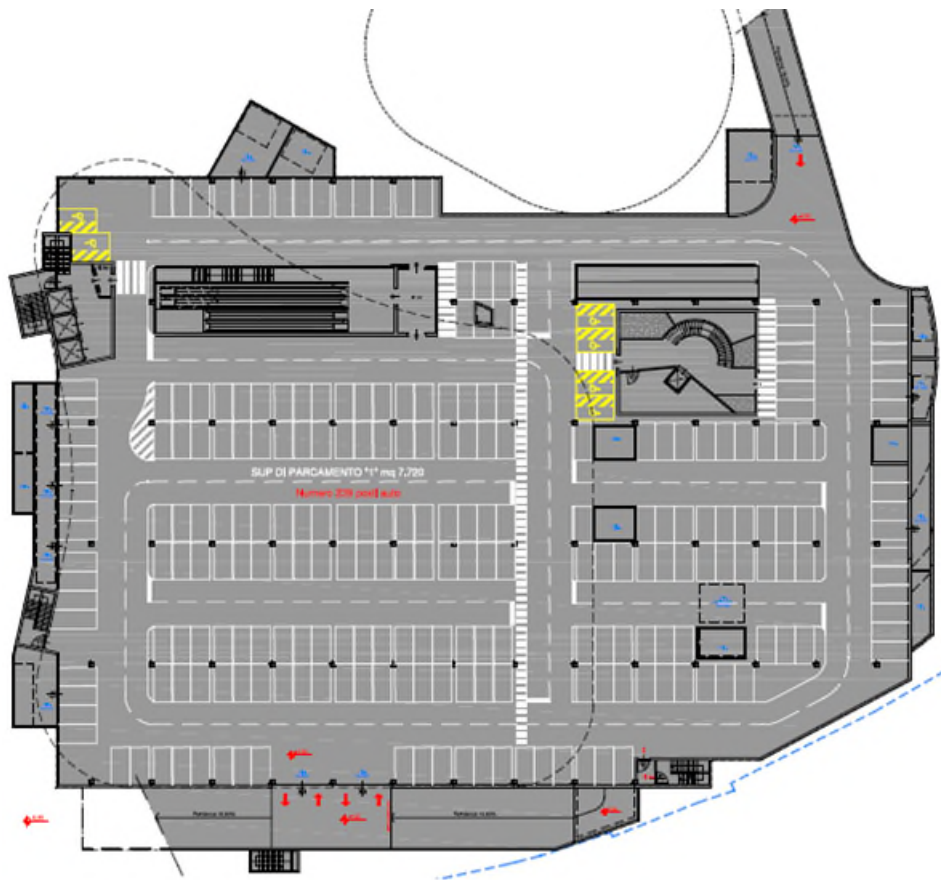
Individuazione aree di sosta – Parcheggio piano -1
